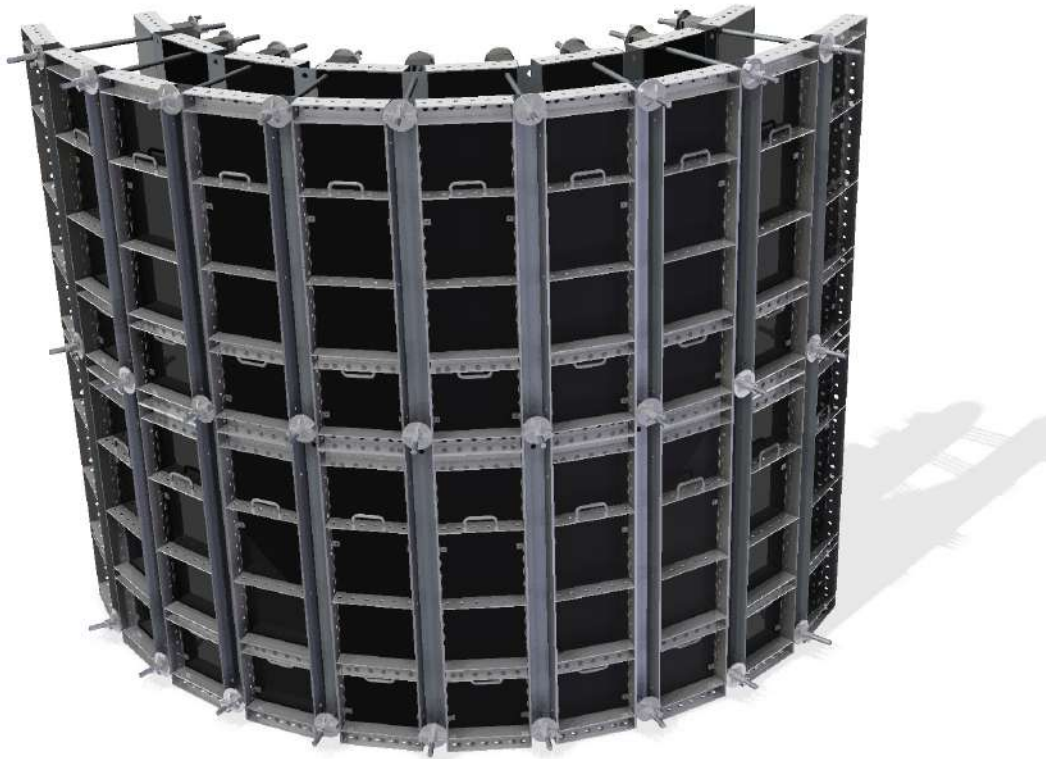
Fôrma metálica Tekko® SH - 40 kN/m² circular
